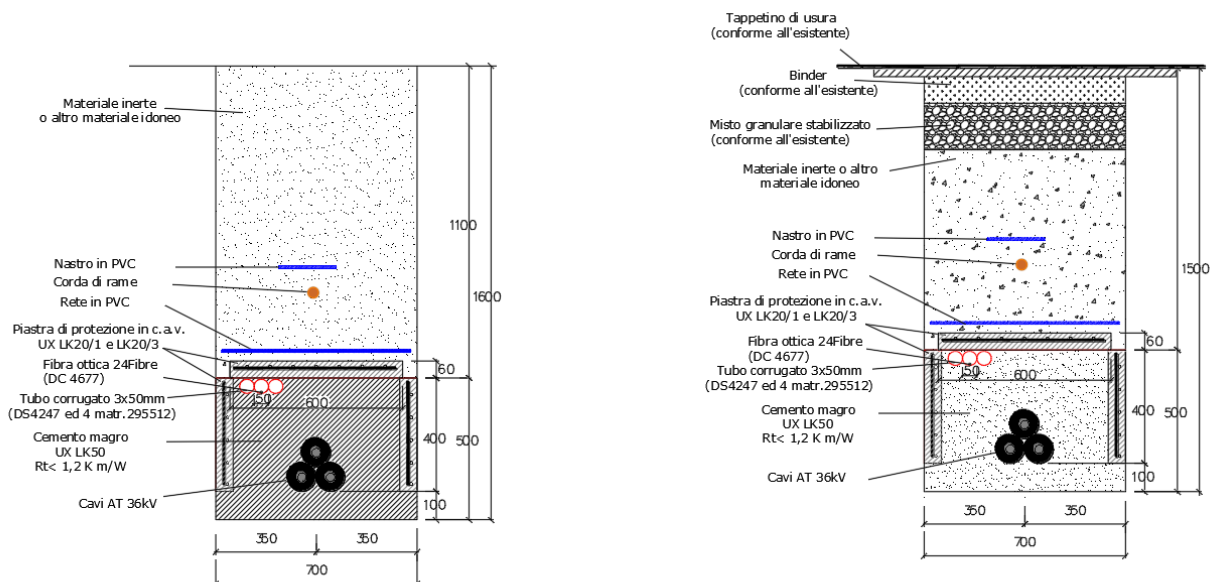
Sezione tipo cavidotto AT 36kV su terreno e su strada asfaltata
